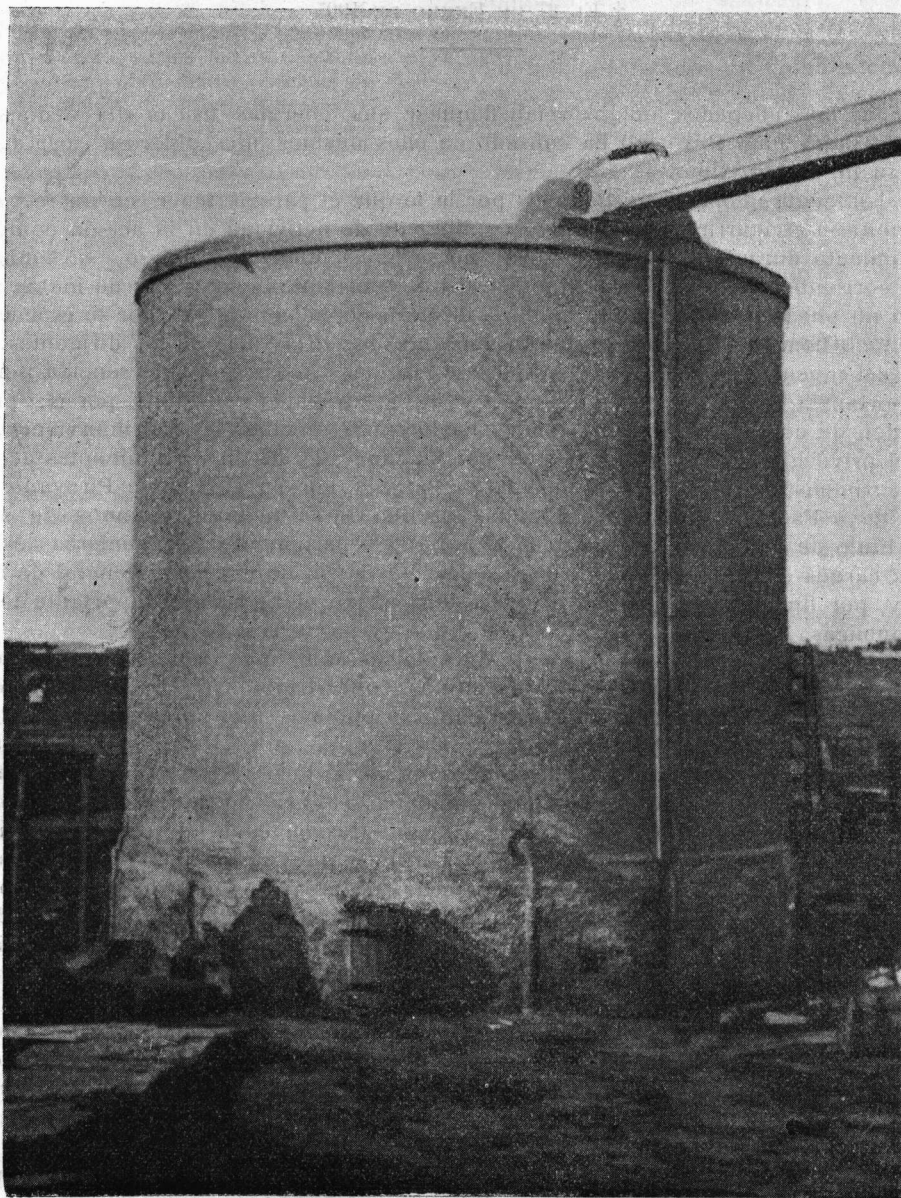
TANQUE DE HORMIGÓN ARMADO, construído en Montevideo por los ingenieros Monteverde y Fabini
